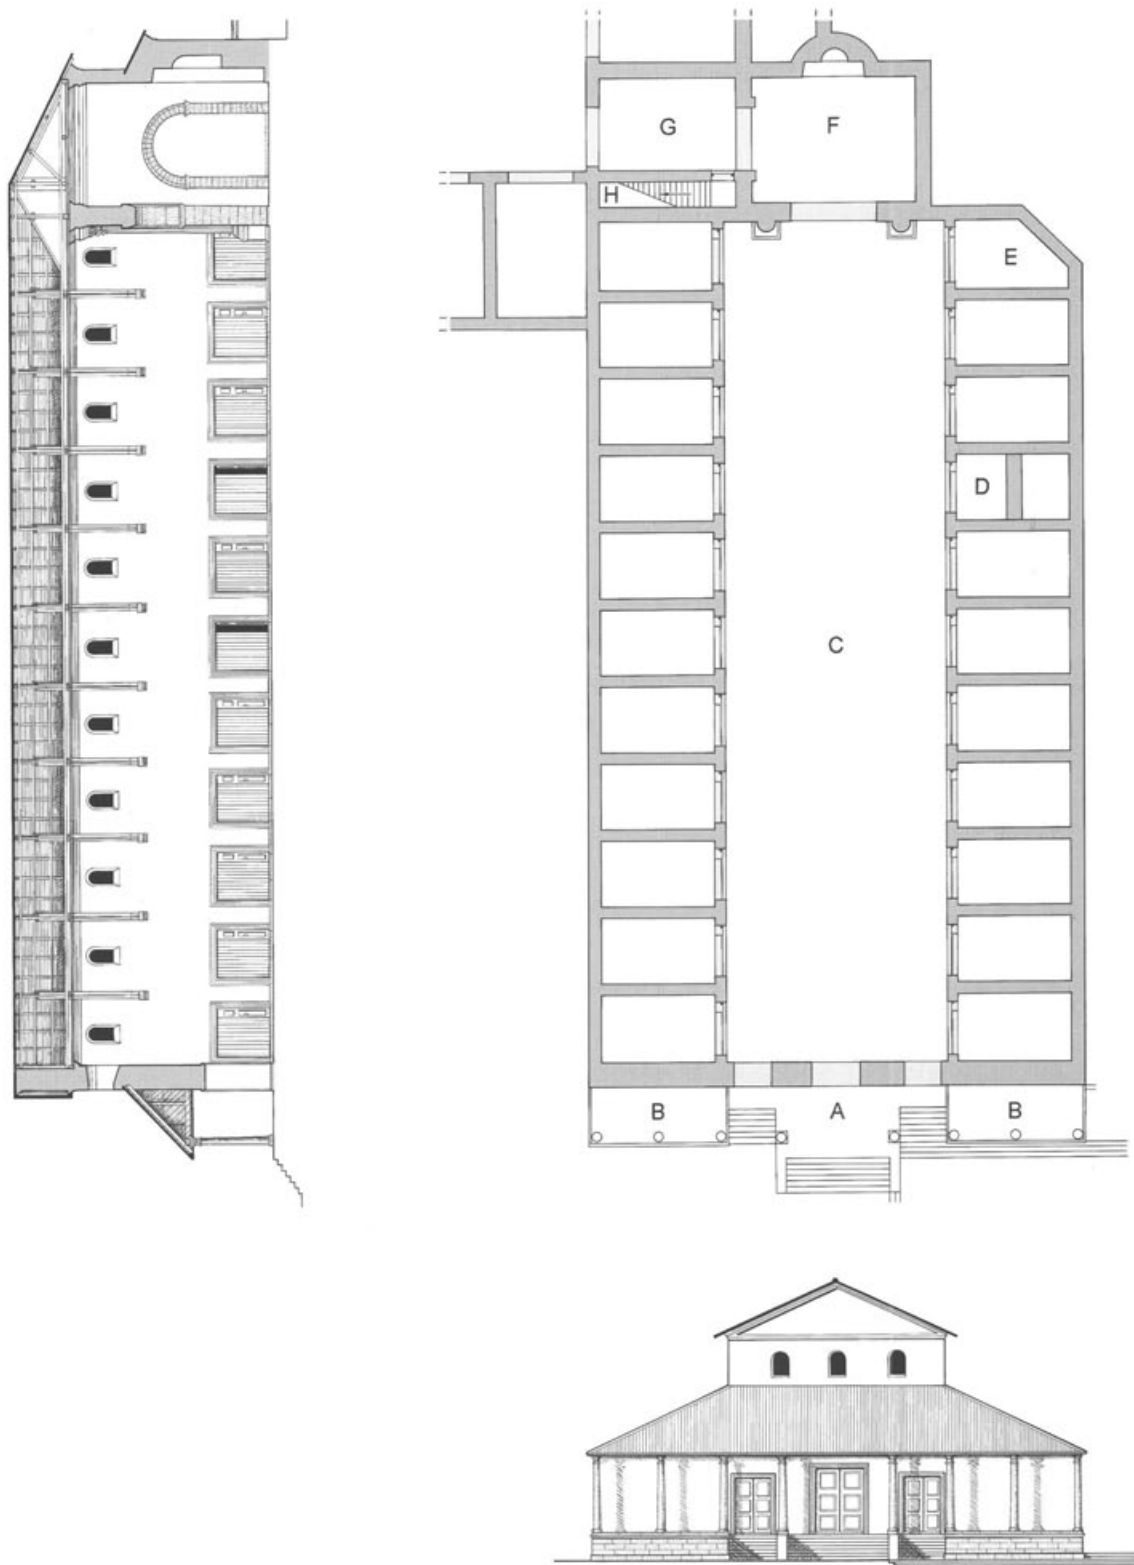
Augst, Nebenforum. Rekonstruierter Grundriss, Längsschnitt und Ansicht an die Nordostfassade. Die Buchstaben beziehen sich auf die im Text erwähnten Stellen. M. 1:400.
